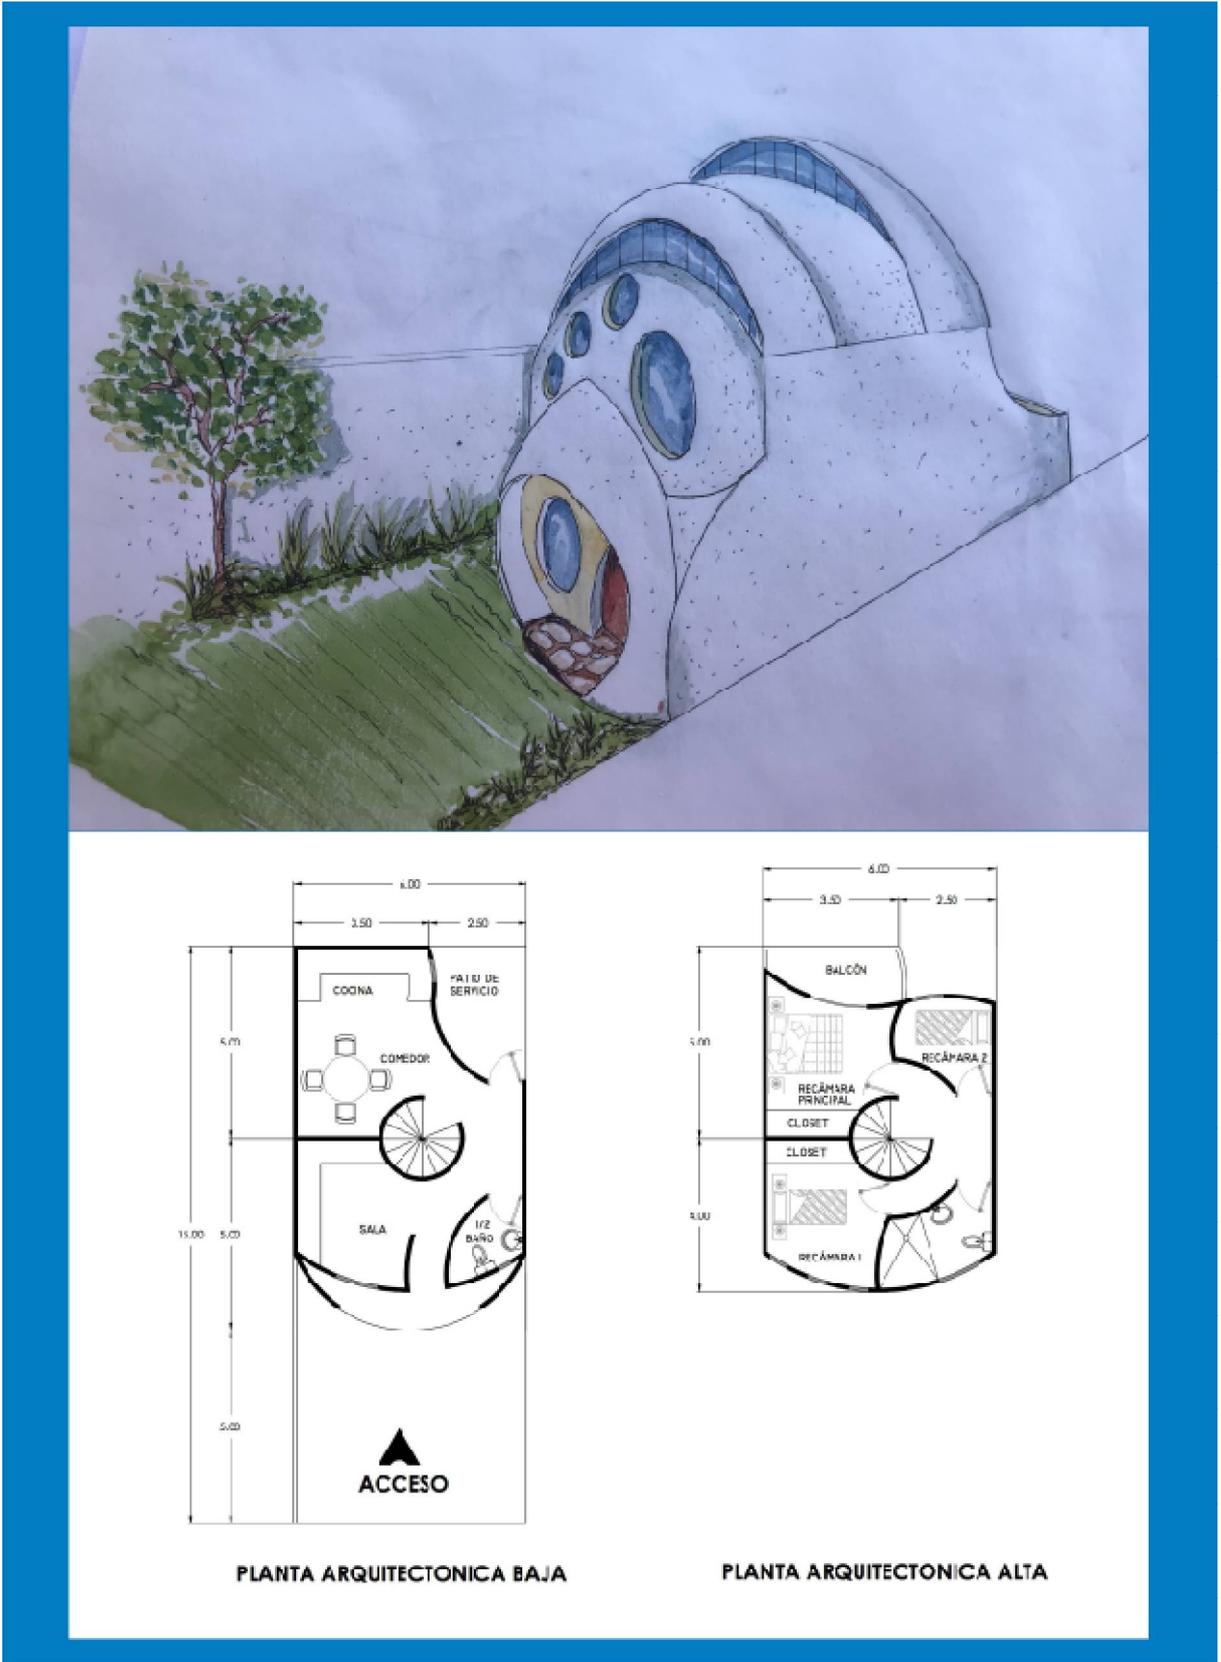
Propuesta 1 – Perspectiva y plantas arquitectónicas-
